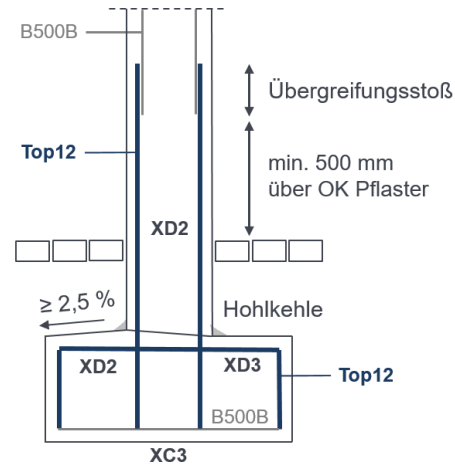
Top12-Ausführungsvariante „Stütze/Fundament“ ohne Oberflächenschutzsystem oder Abdichtung, Fundament an der Oberseite bewehrt. (Quelle: Steeltec AG)
